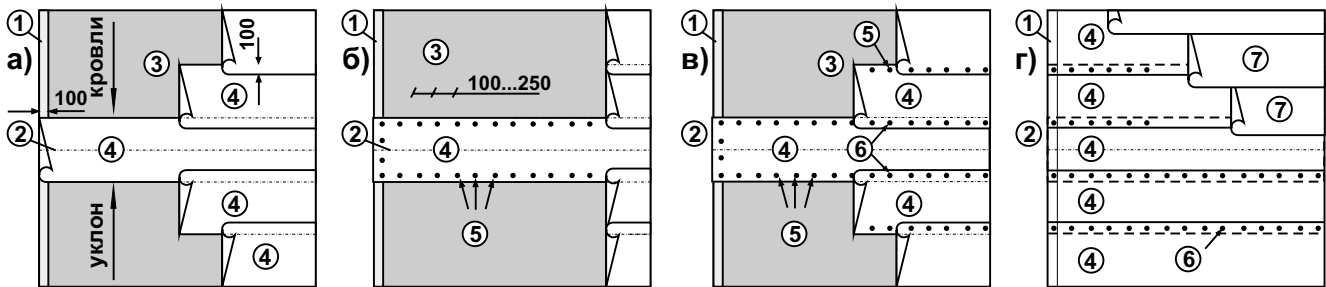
Пример раскладки рулонных материалов при устройстве кровельного ковра с механическим закреплением нижнего слоя.
